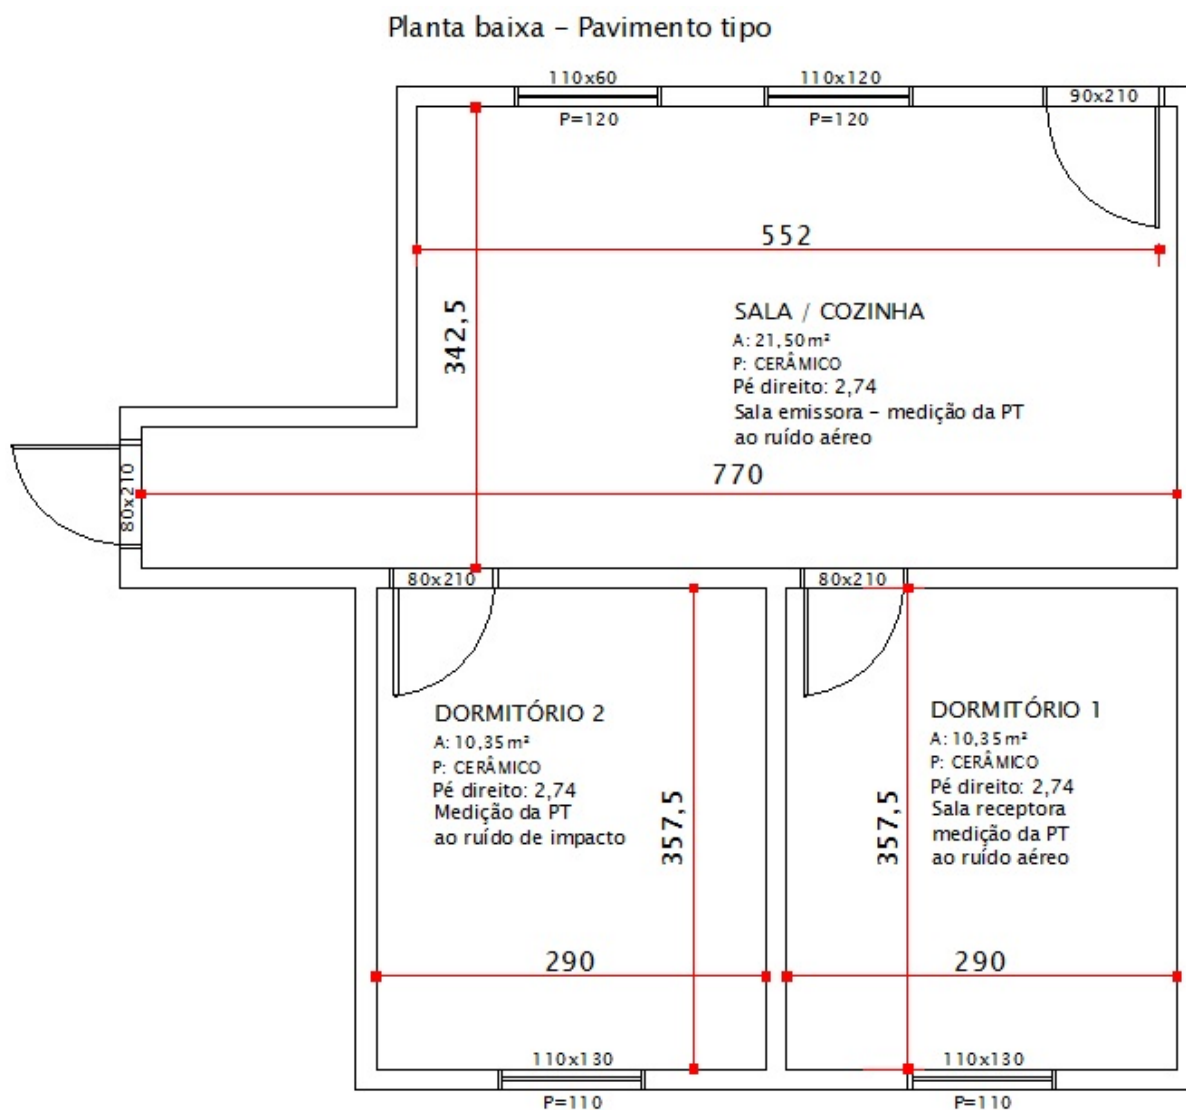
Planta baixa - pavimento tipo - 03-PIS-TV-PC
